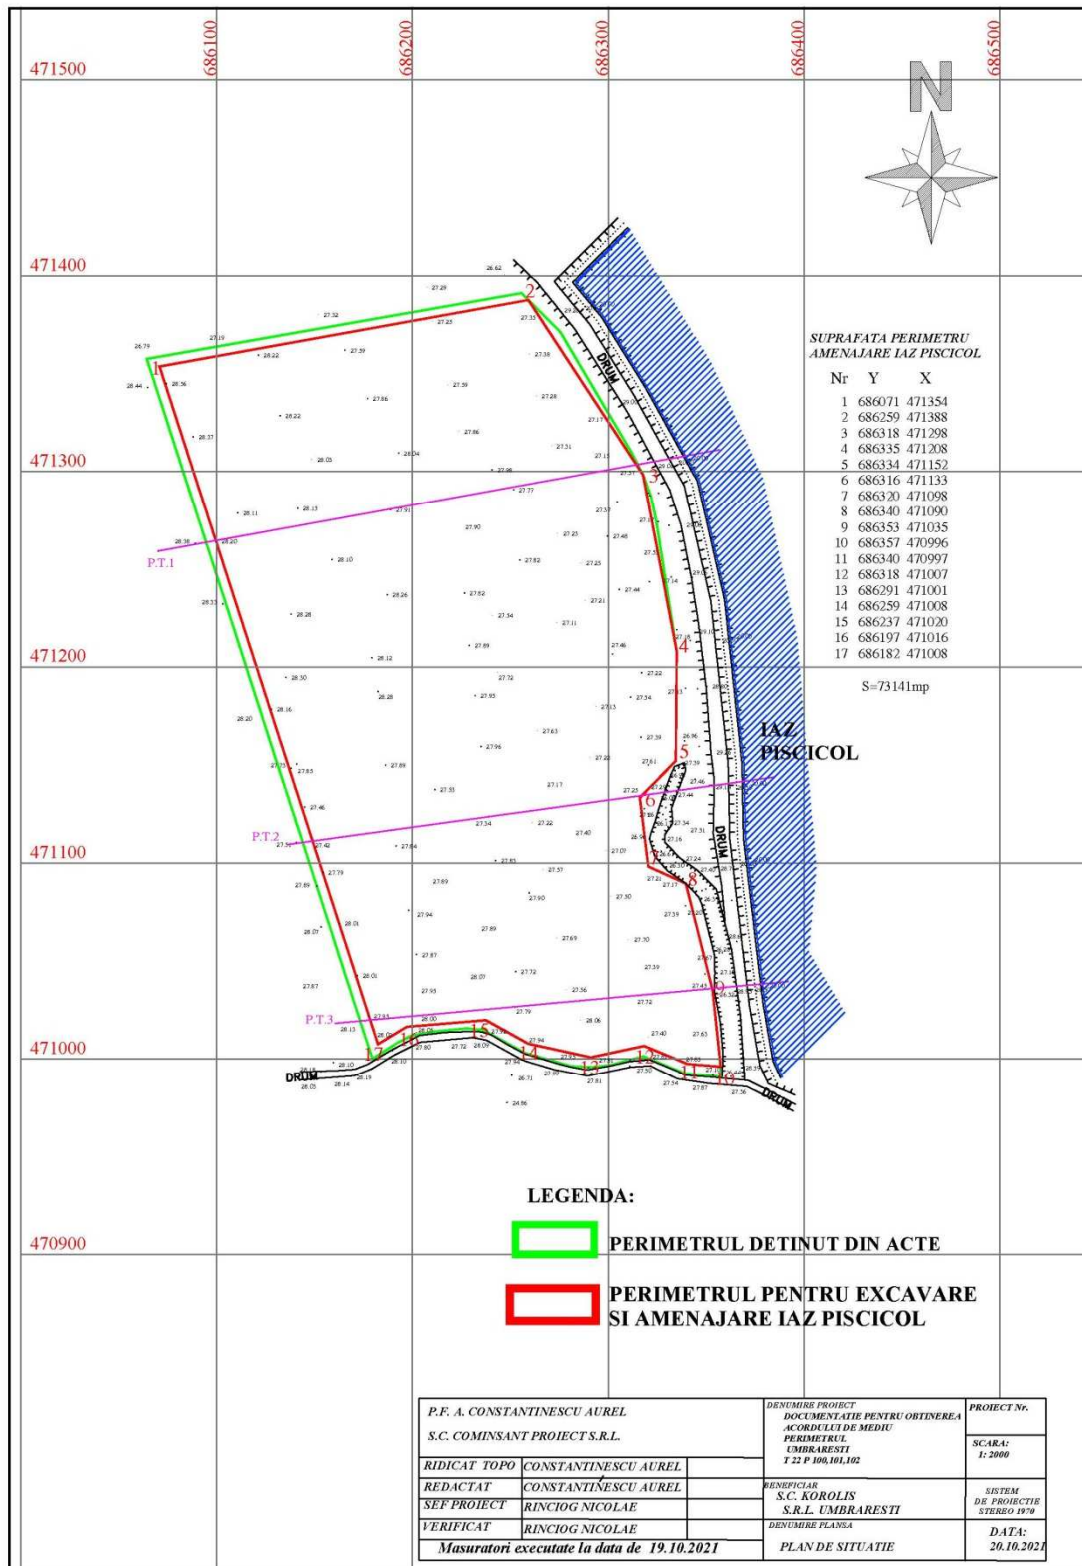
Plan de situație – Perimetrul Umbrărești T22
